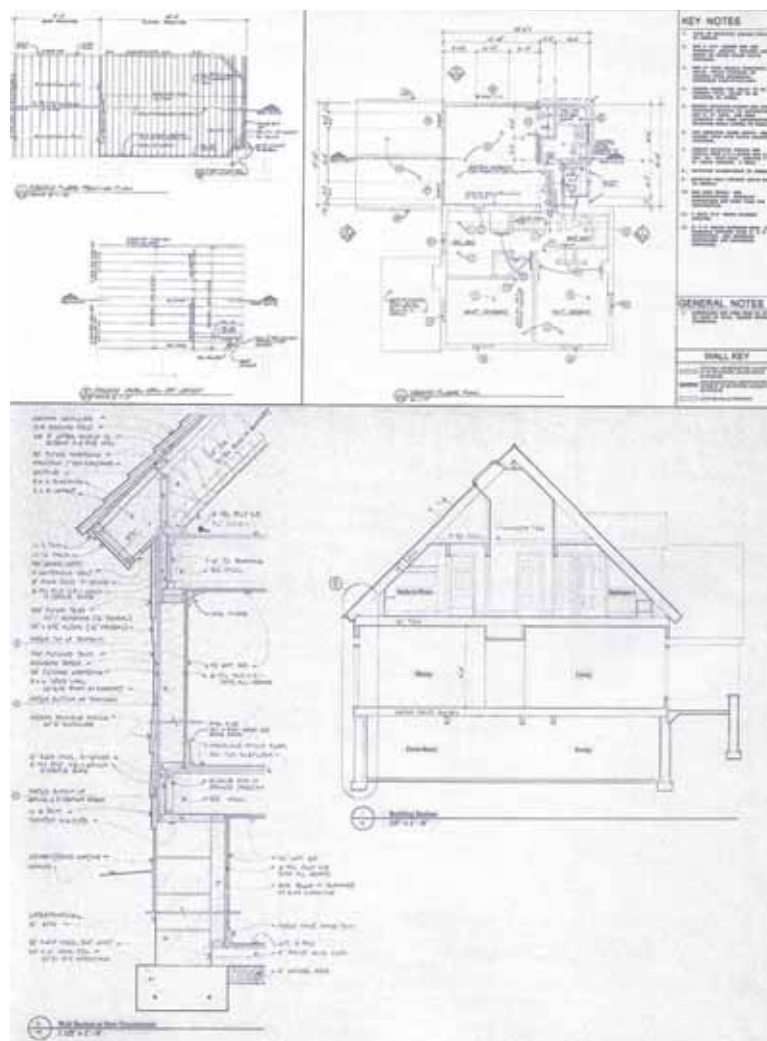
Planta e detalhes de obra de *wood-frame* americano.
